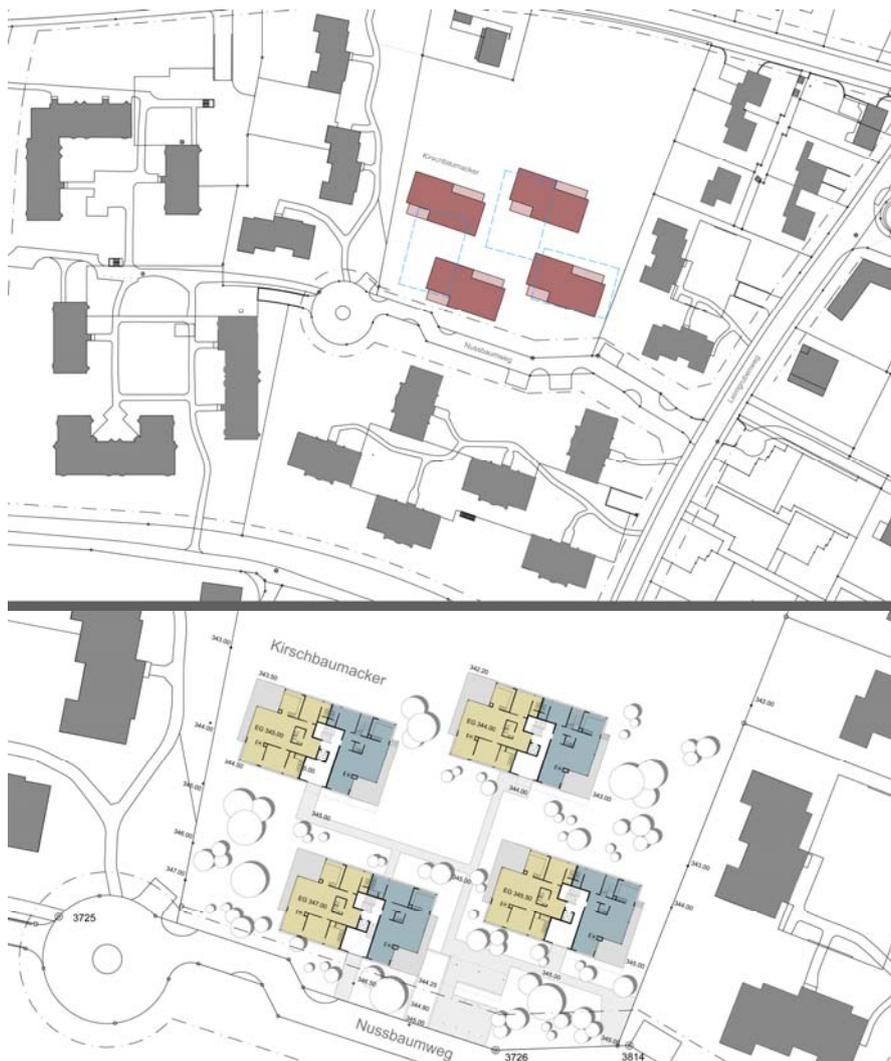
Situationsplan und Grundriss EG Neubauprojekt
